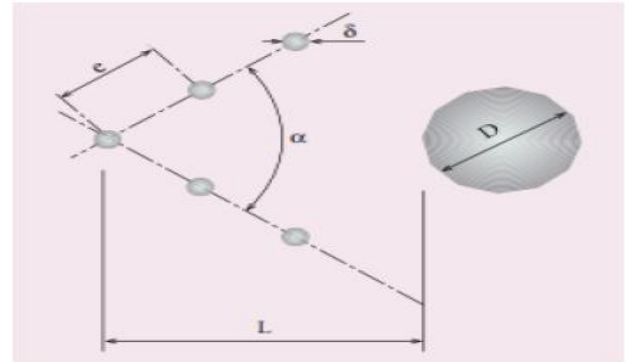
Vue en plan d'une protection contre l'affouillement par îlots.
